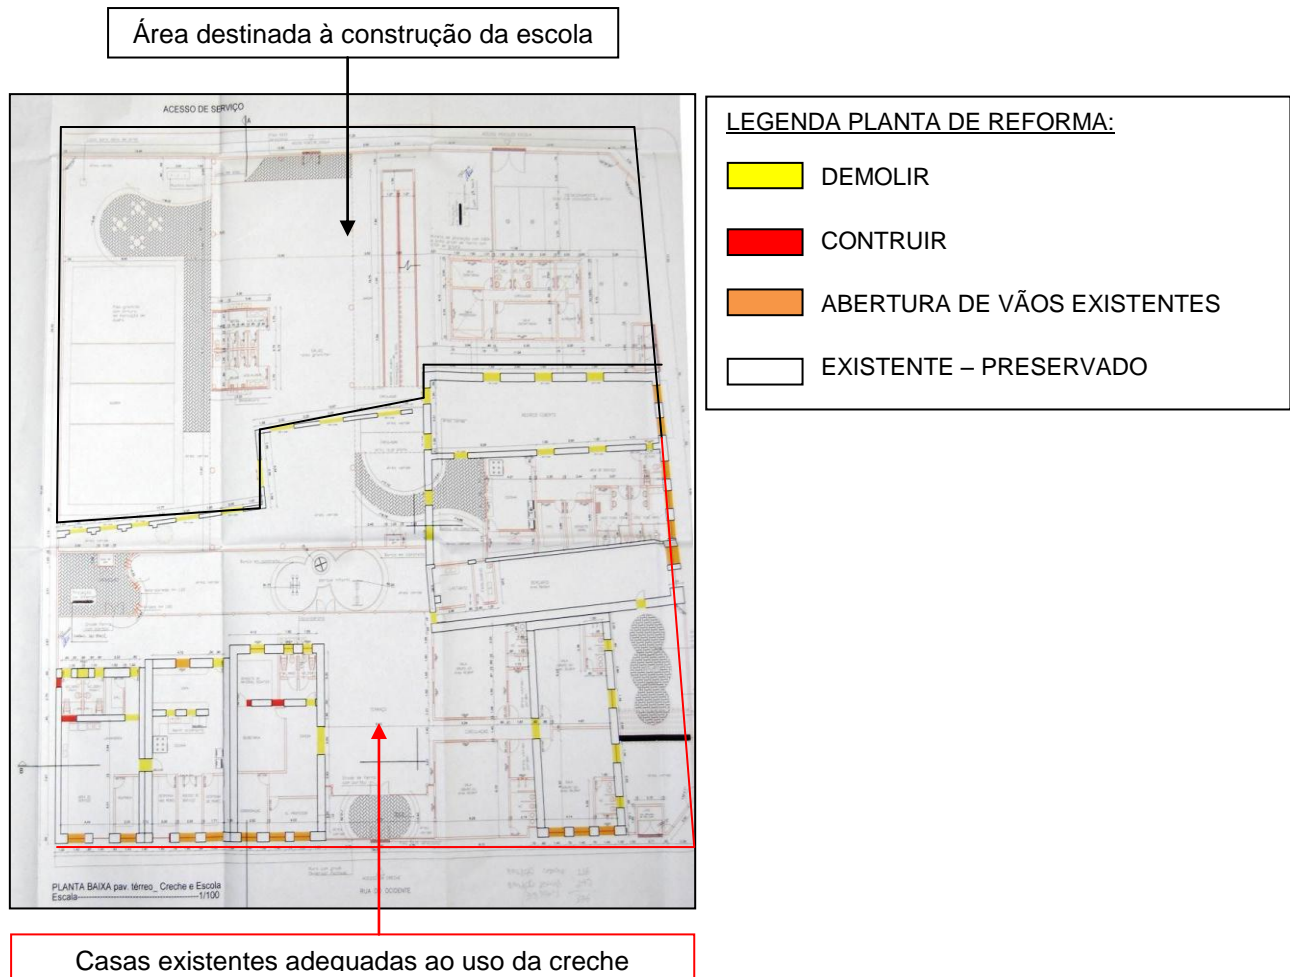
planta de reforma da creche e de construção da escola – 1º pavimento
